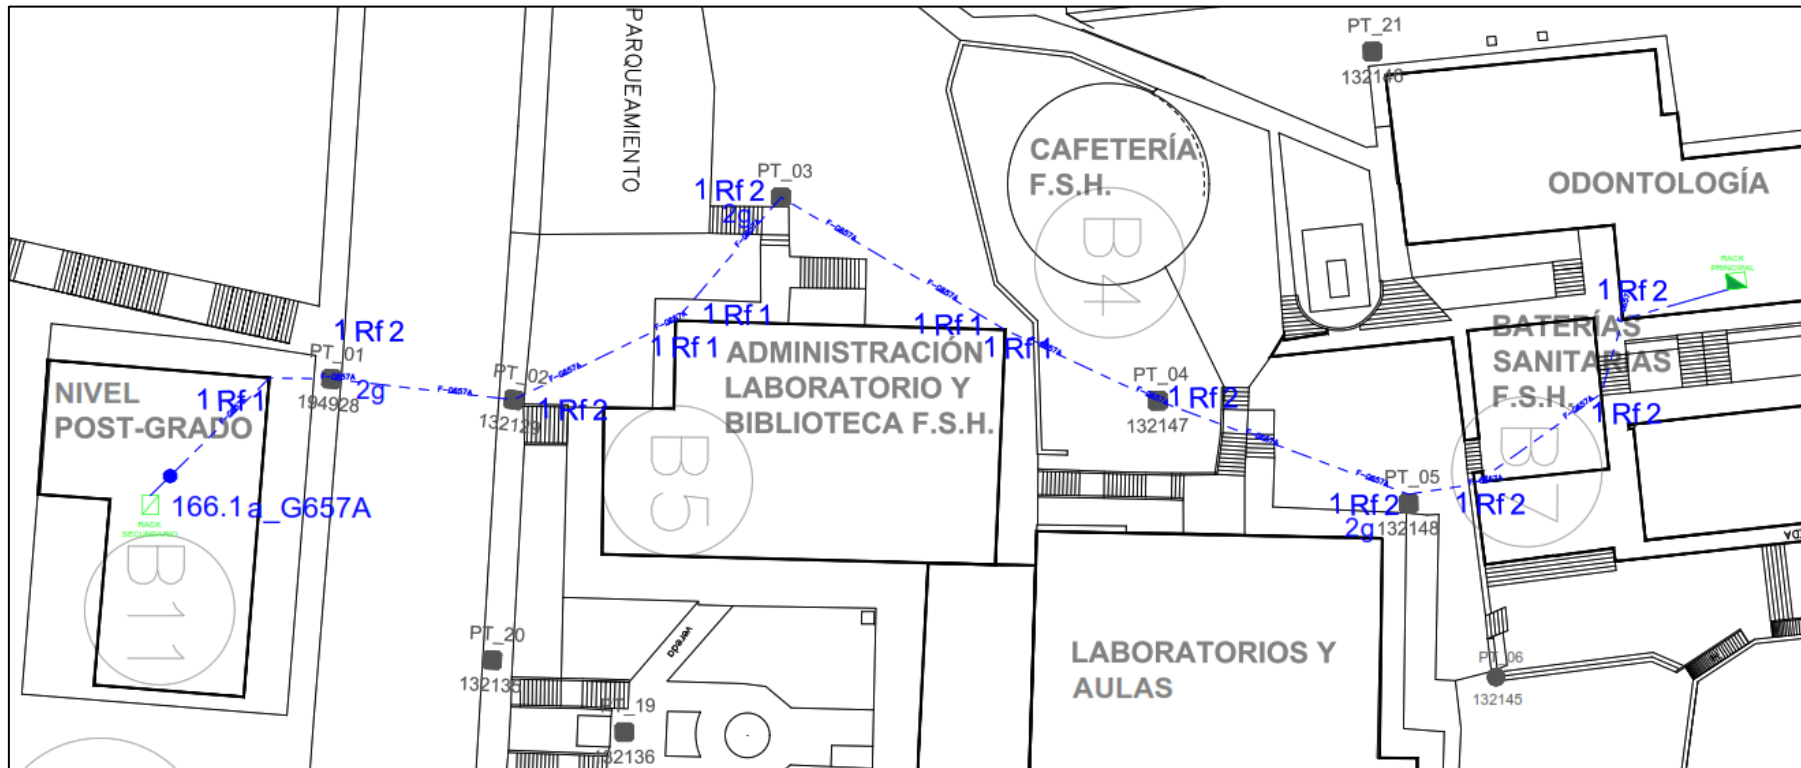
Planimetría del tendido aéreo para el enlace de fibra óptica del bloque 11.
